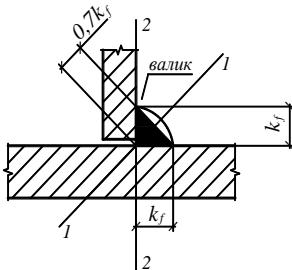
Схема расчетных сечений сварного соединения с угловым швом
